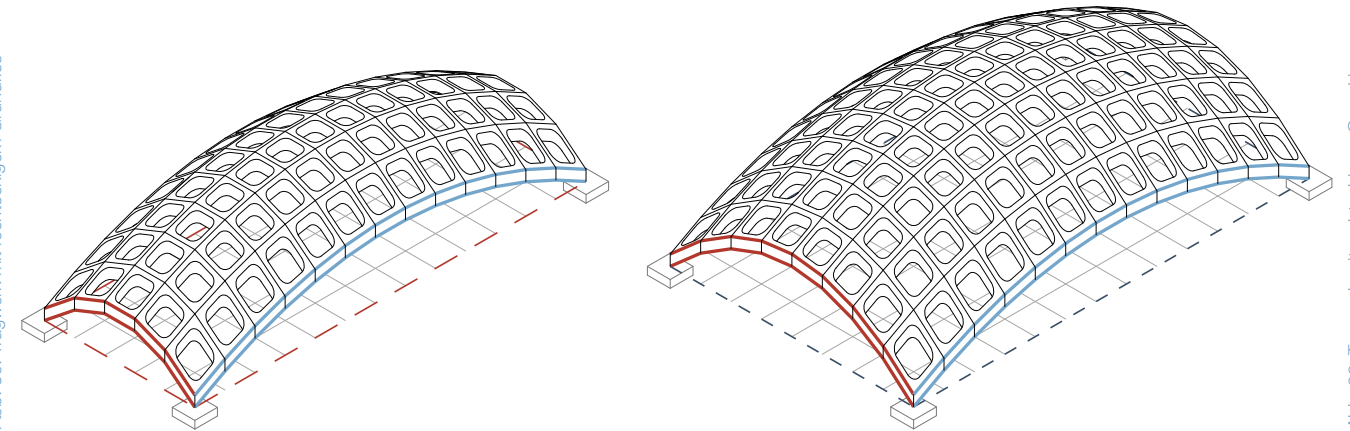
Tragwerk mit rechteckigem Grundriss
